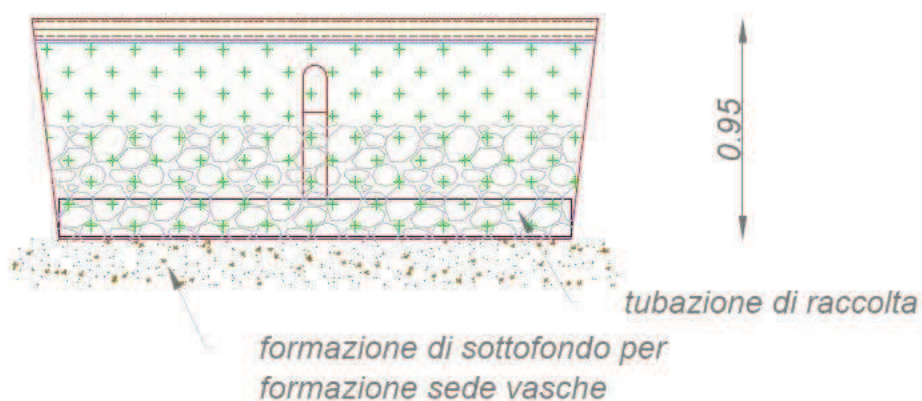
Sezione B-B' scala 1:50; (fonte: Parco dell'Adamello)
